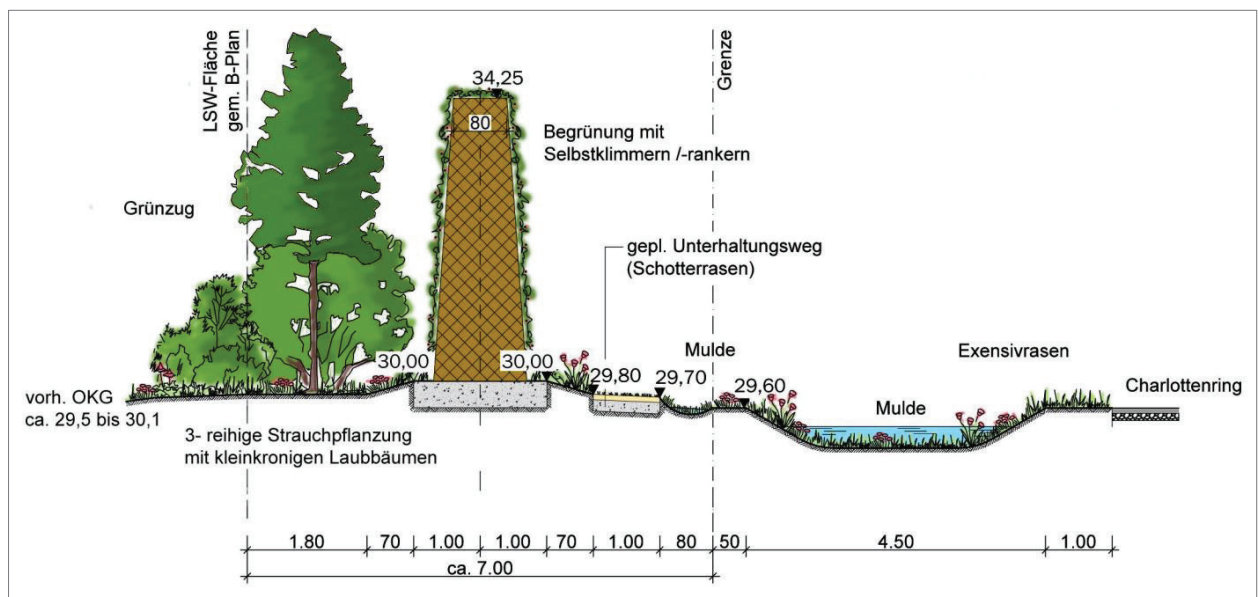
Systemschnitt B – B' / Lärmschutzwand, unmaßstäblich
